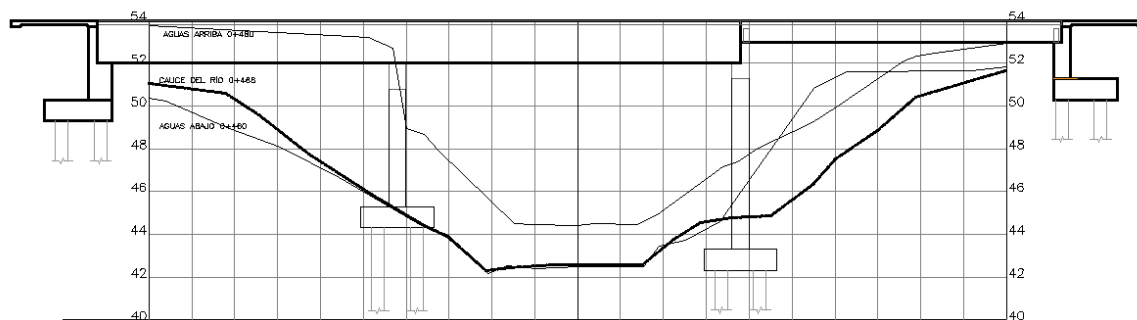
Vista longitudinal del puente sobre el río Jermud.
